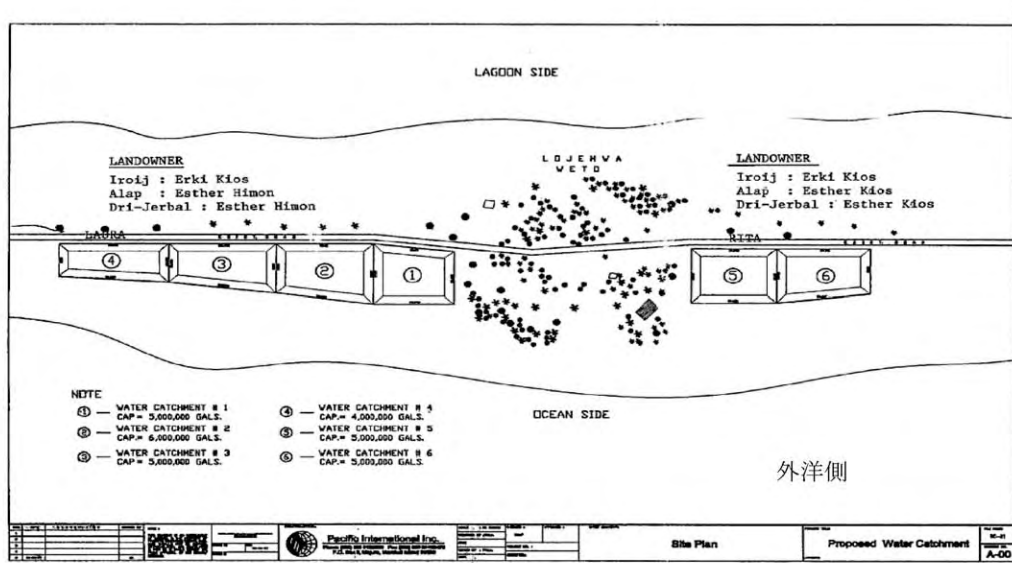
「マ」国側が要請してきた貯水池の平面図
